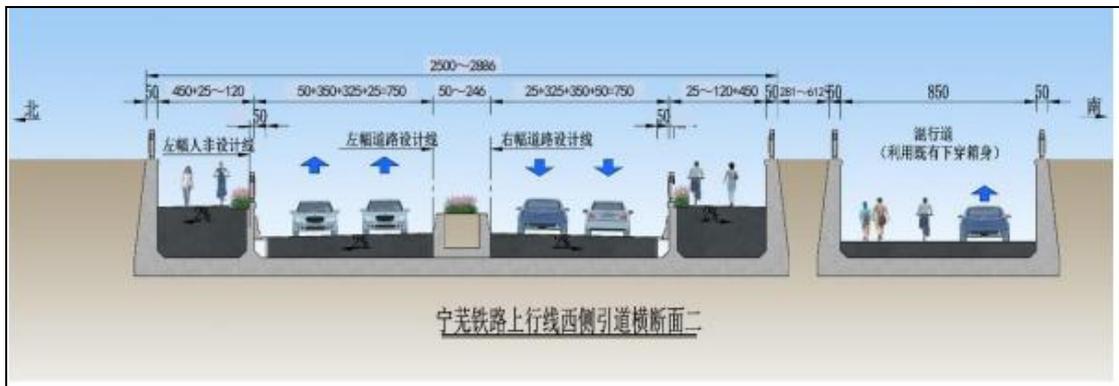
下穿宁芜铁路上行线西侧引道横断面图
